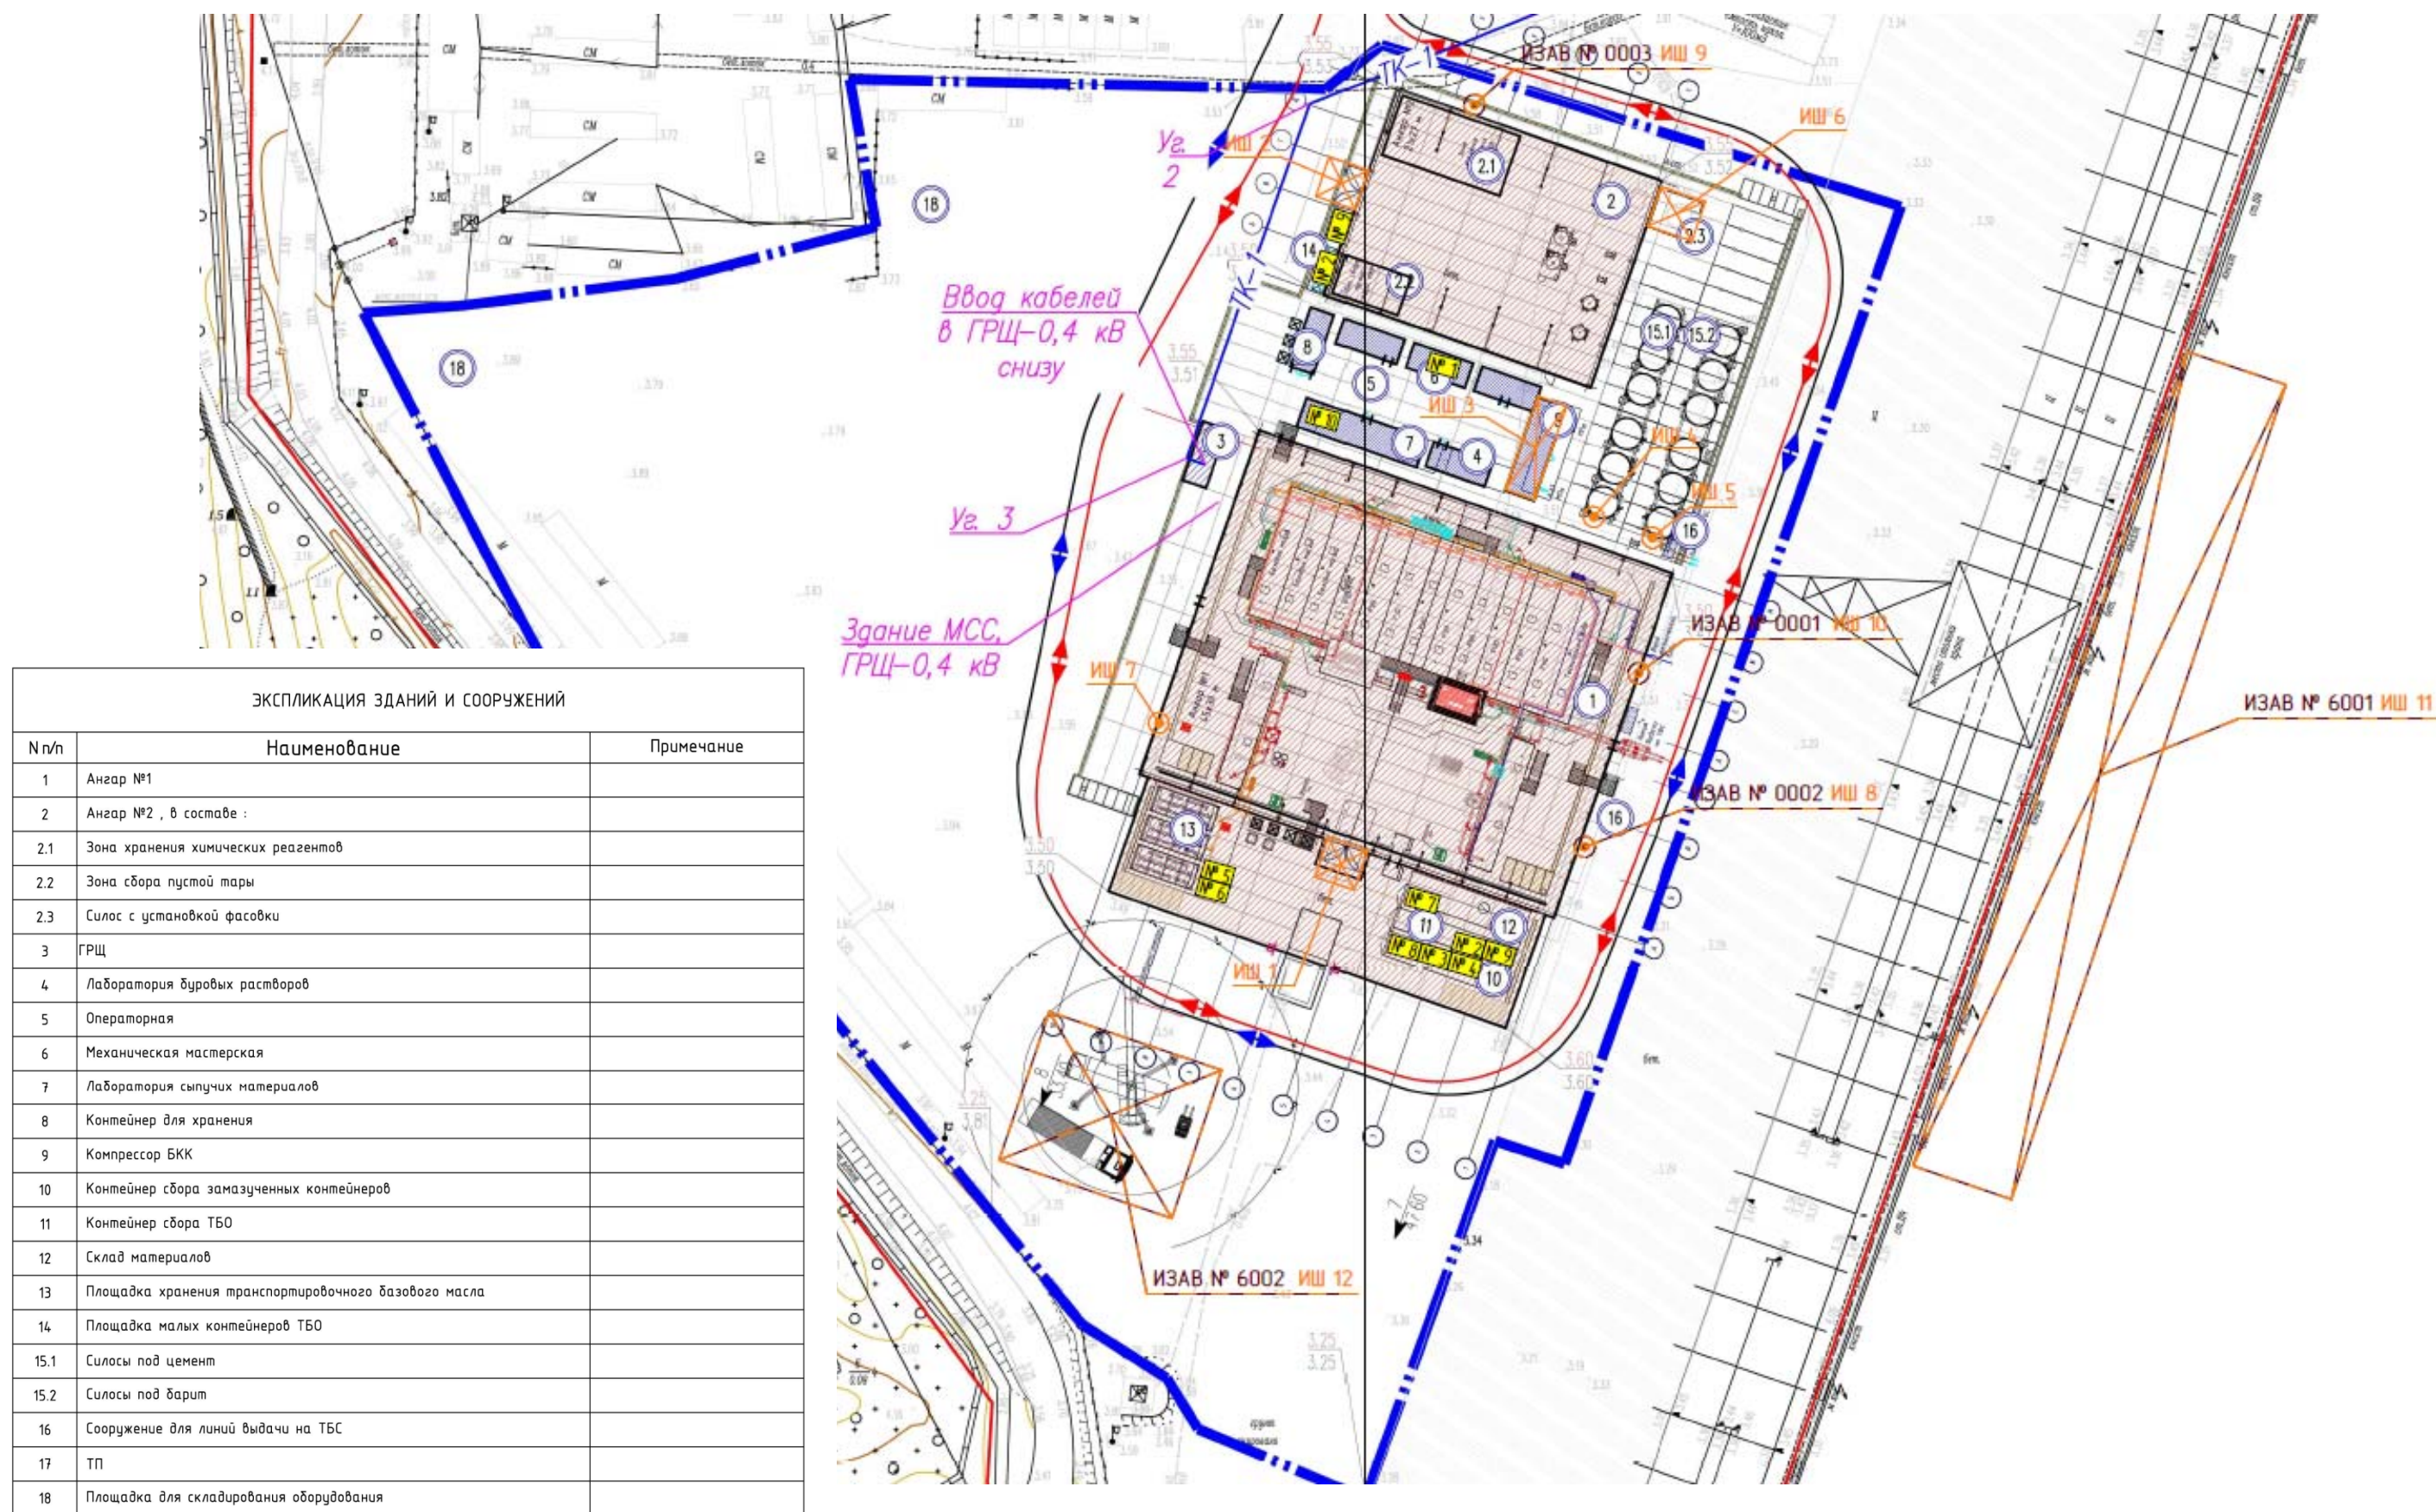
Схема размещения зданий и сооружений на площадке ББО
